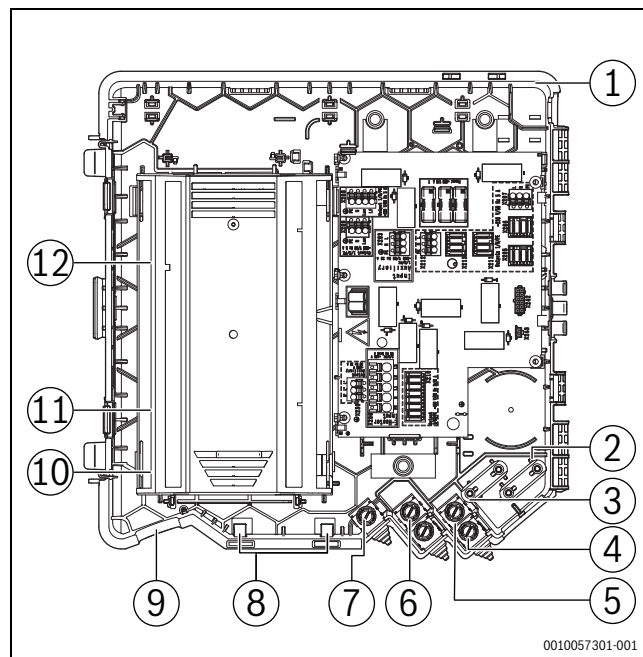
Passaggio dei cavi nella scatola elettrica (alimentazione principale, accessori e bassa tensione)
